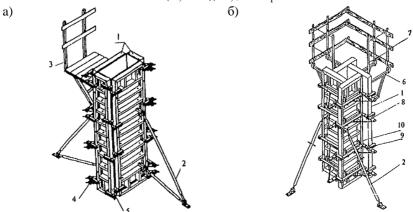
Крупнощитовая модульная опалубка колонн а – опалубка колонн (на замках); б – опалубка колонн (на хомутах): 1 – щит, 2 – подкос, 3 – подмости для бетонирования, 4 – замок, 5 – угольник, 6 – кронштейн подмостей, 7 – ограждение, 8 – хомут, 9 – замок, 10 – петля для удержания хомутов
